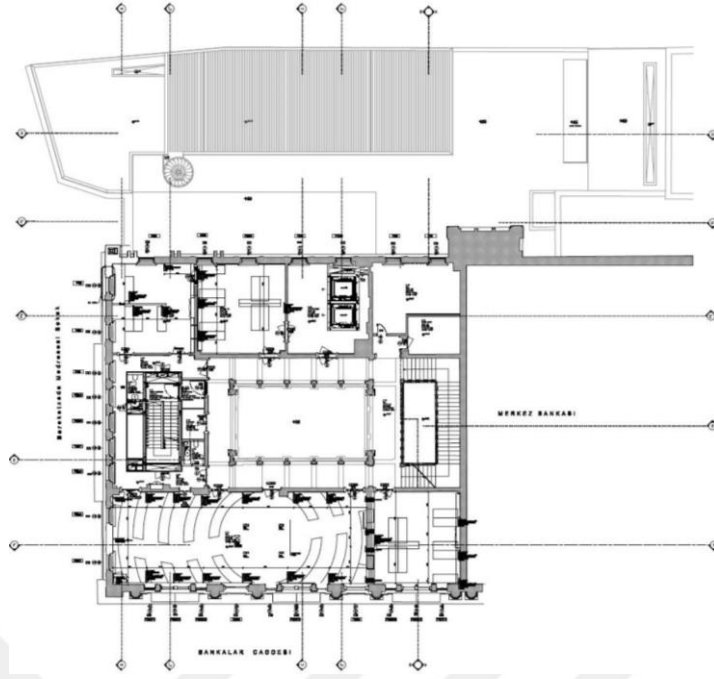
SALT Galata birinci kat planı. (Fotoğraf: www.arkitera.com)
